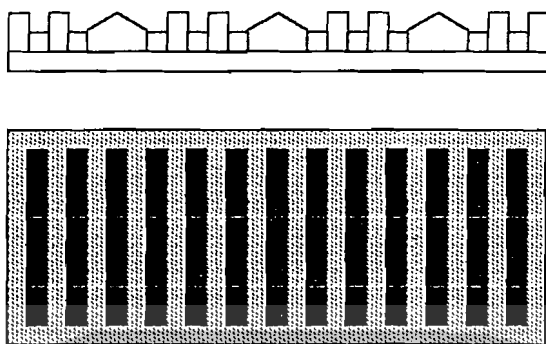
Ornament Pada Bangunan H. Garuda
